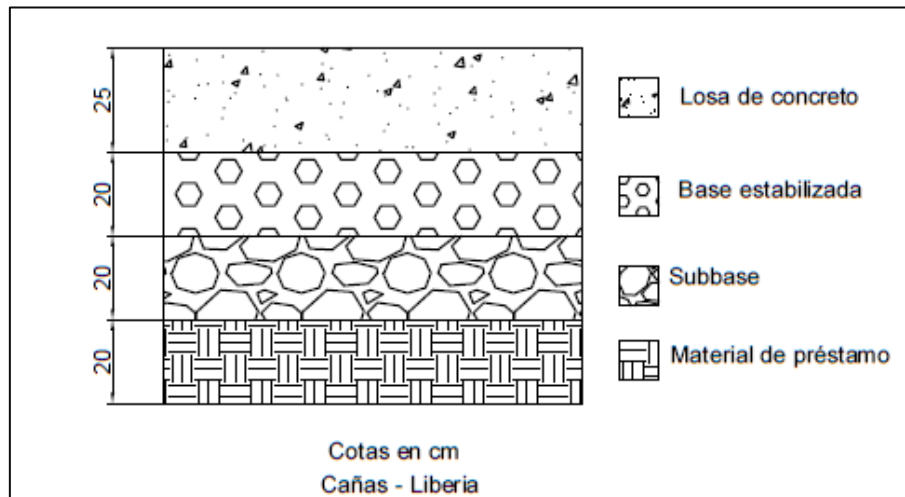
Estructura de pavimento de la ruta Cañas Liberia
